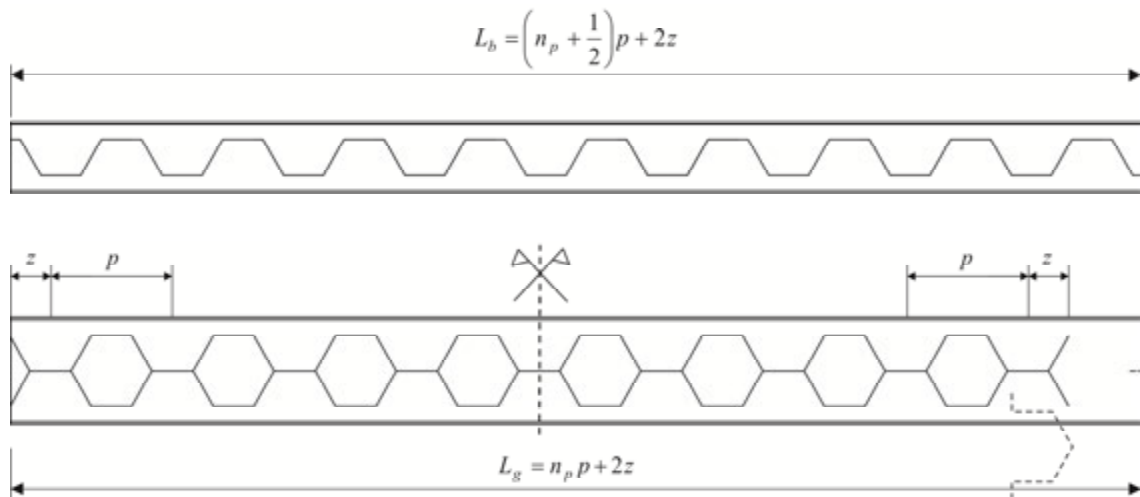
Esquema de corte e soldagem de viga alveolar com o passo considerado a partir do meio do montante (BLODGETT, 1966).
